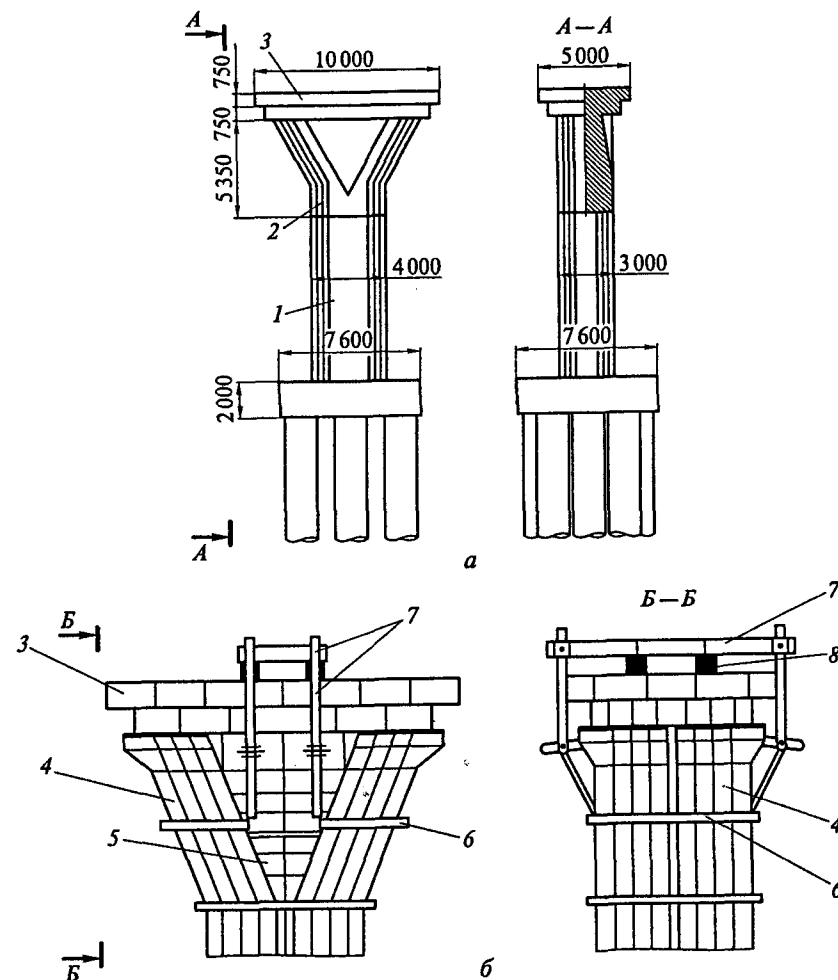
Конструкция опалубки тела опоры сложной формы:
